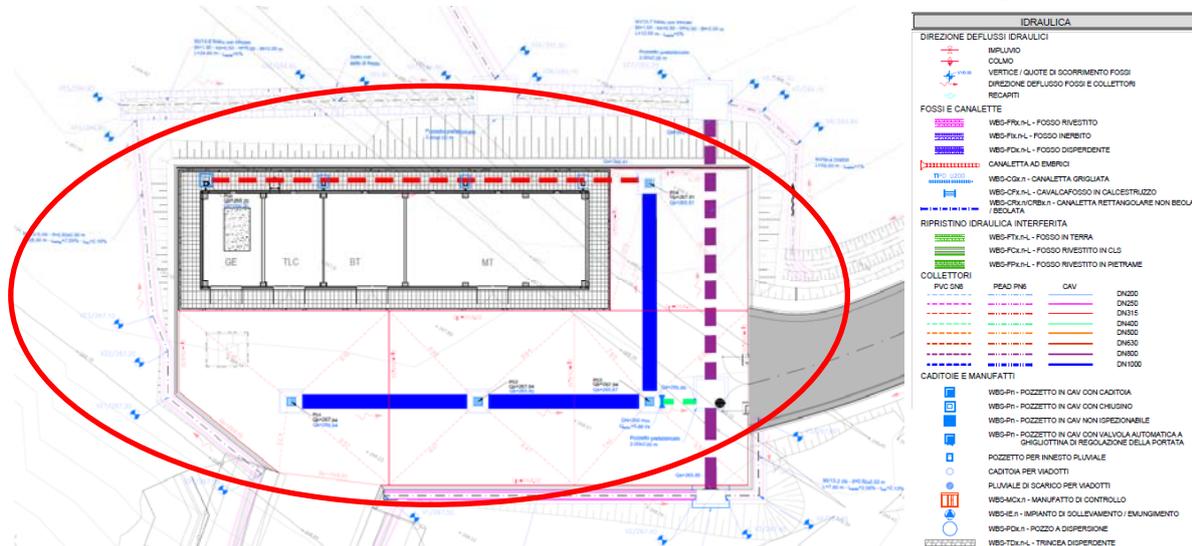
Planimetria della sistemazione del piazzale RI59 come da prescrizione in oggetto
